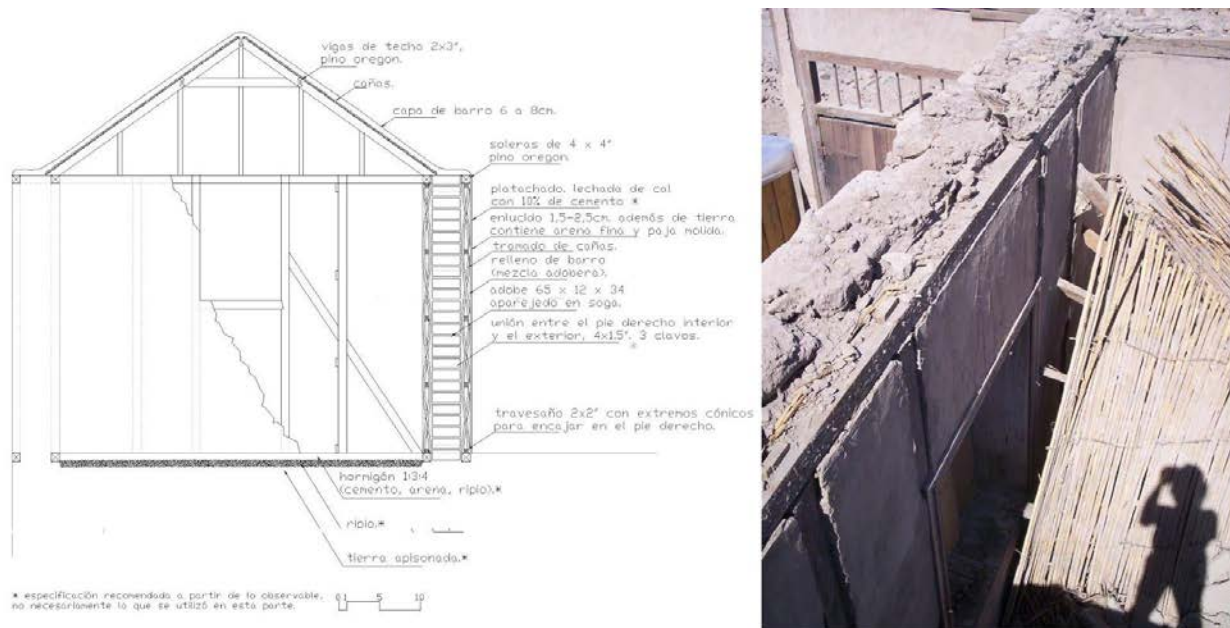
La Casona. Planta y corte mostrando los elementos estructurales del muro
